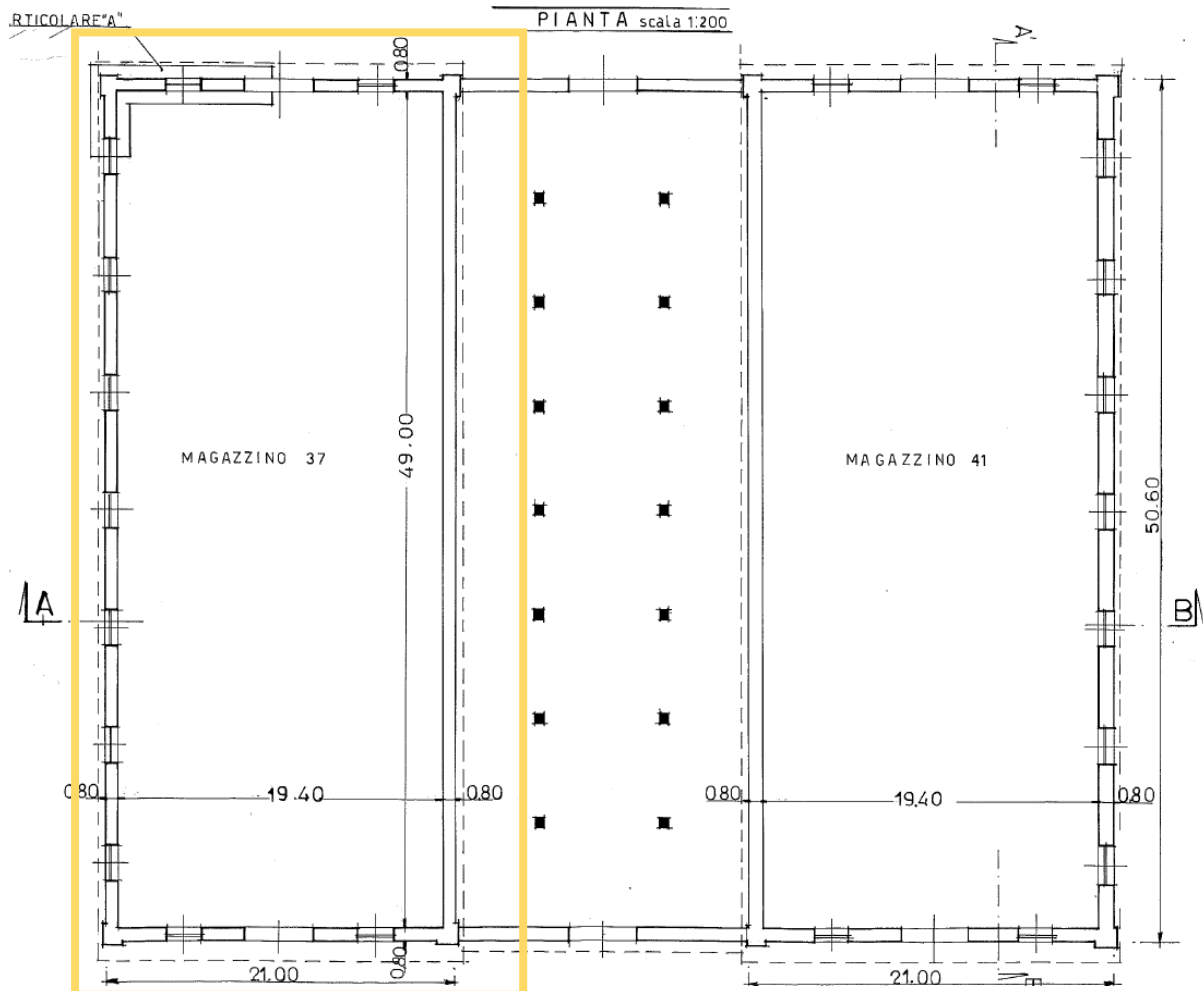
Planimetria lotto magazzini D38A, D39A e D40A
